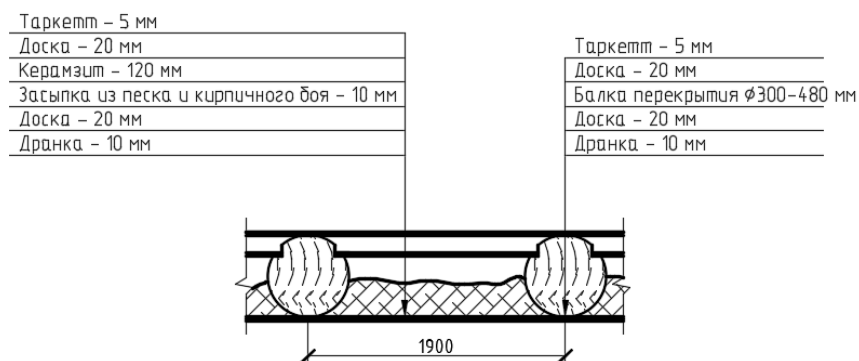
конструкция перекрытия между 3-м и 4-м этажом
